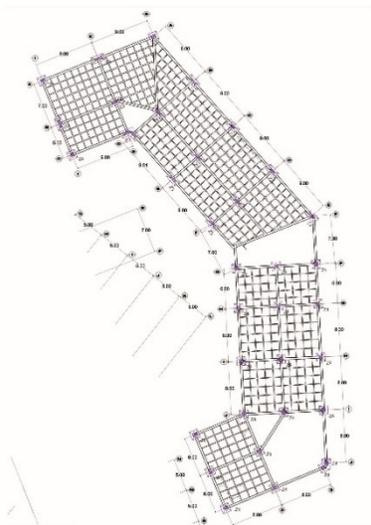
Plano de planta de entepiso sector del parqueadero Fuente: (Autoria, 2020)
